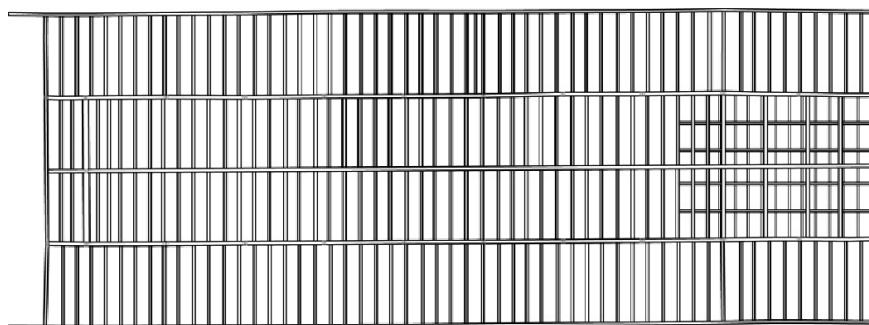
Iglesia de Chonchi, Estructura de suelo planta baja
